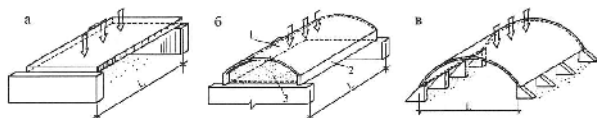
Схемы конструкций: а – плоской плиты; б – цилиндрического свода – оболочки; в – цилиндрического свода; 1 – оболочка; 2 – бортовой элемент оболочки; 3 – диафрагма жесткости
